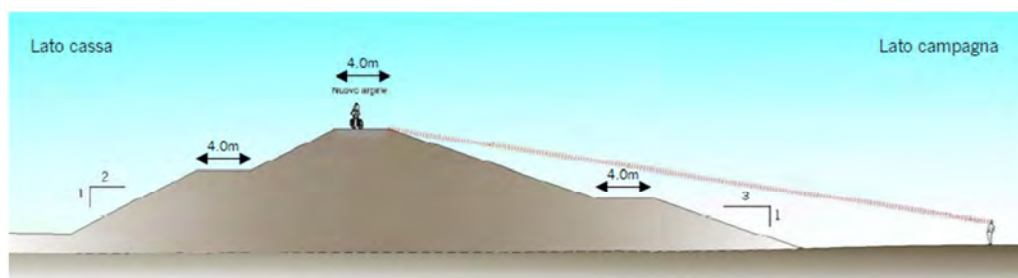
Sezione arginale tipo (da “Relazione Generale” del progetto definitivo [1])
